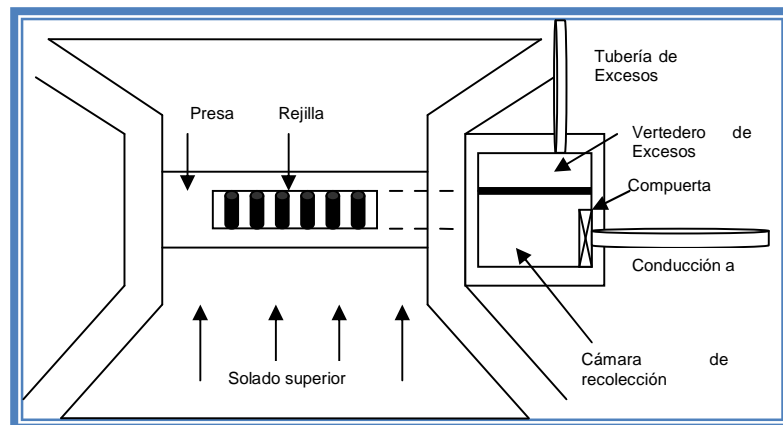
Bocatoma de fondo – Planta (adaptado por López Cualla)¹.
